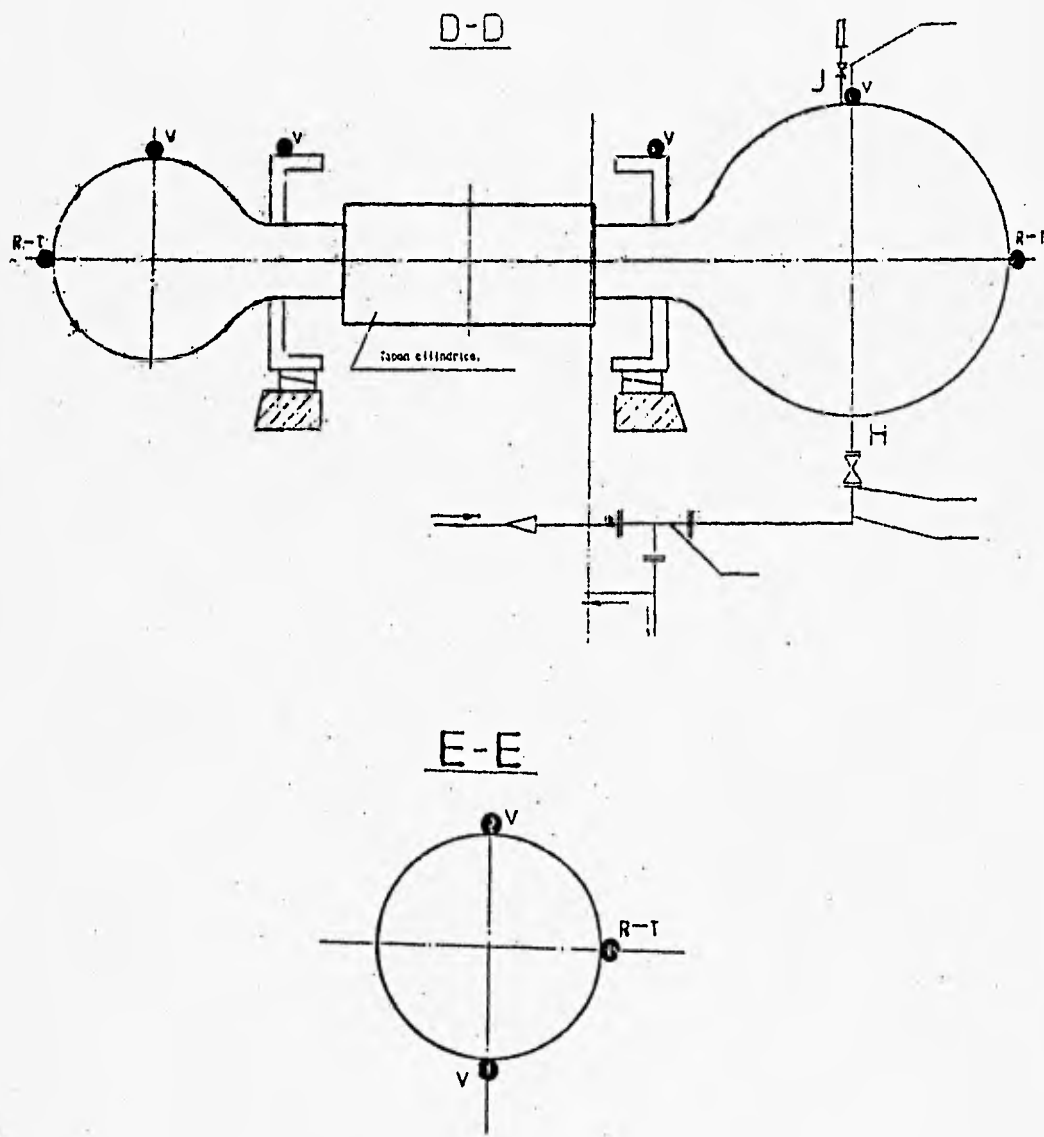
UBICACIÓN DE VÁLVULAS PARA LLENADO DE CÁMARA Y POSICIÓN DE DEFORMÍMETROS.
